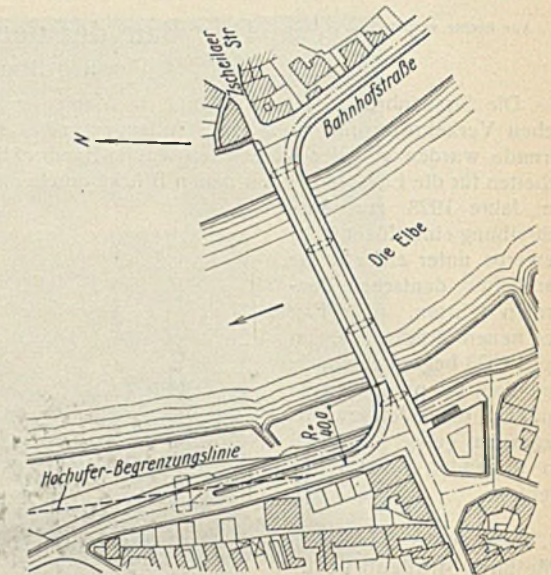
Preisgekrönter Entwurf des Ideenwettbewerbs, zur Ausführung vorgeschlagen.
